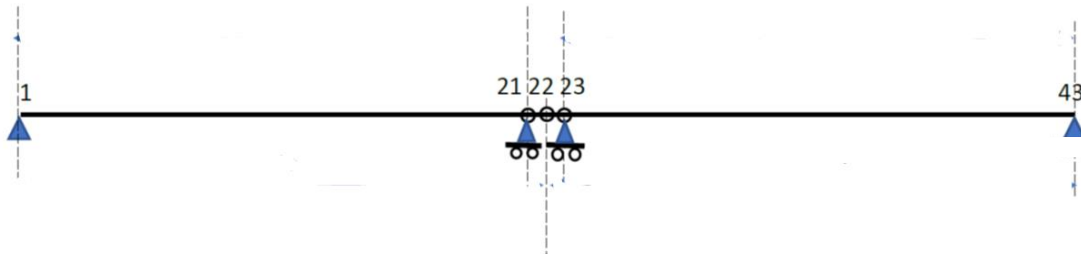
Disposición de los apoyos y su tipo
